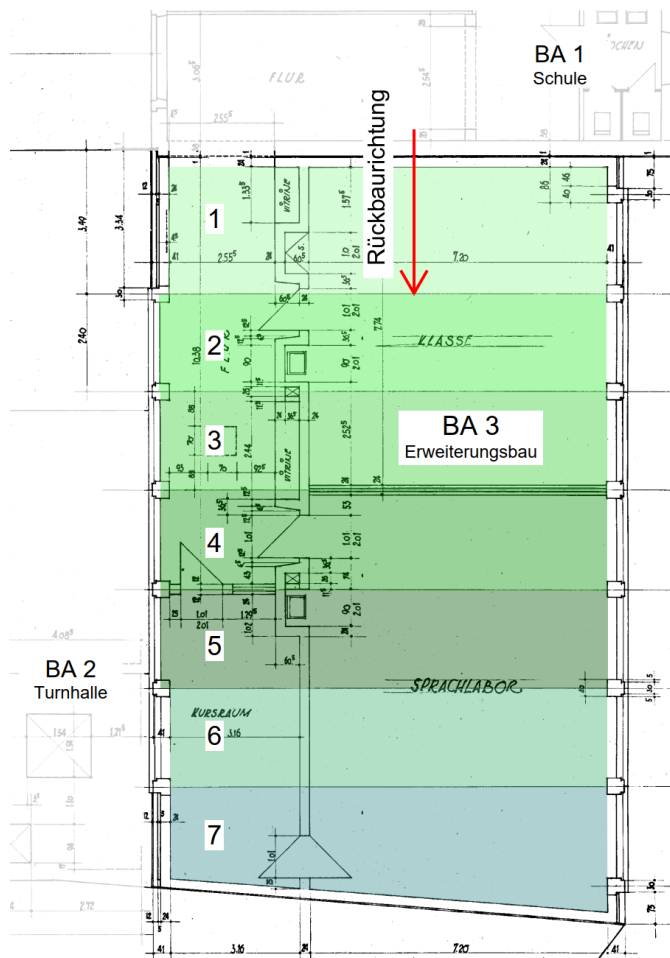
Darstellung Rückbau Decken, Ausschnitt aus [1]
